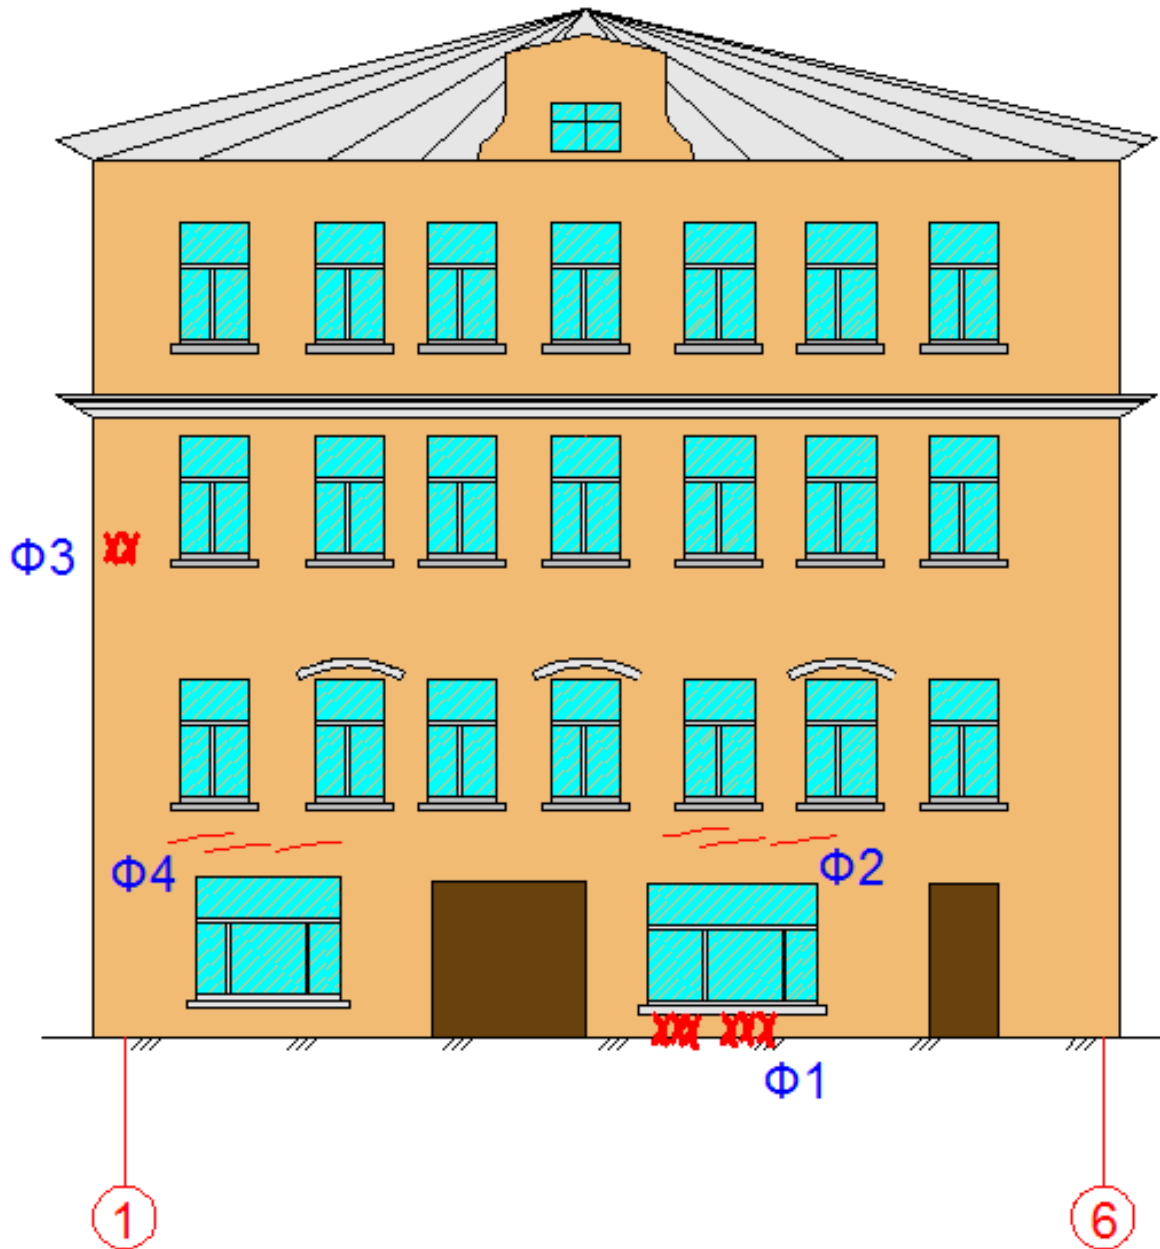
Схема дефектов фасад по оси «Е». Фасад со стороны _____ проспекта.
